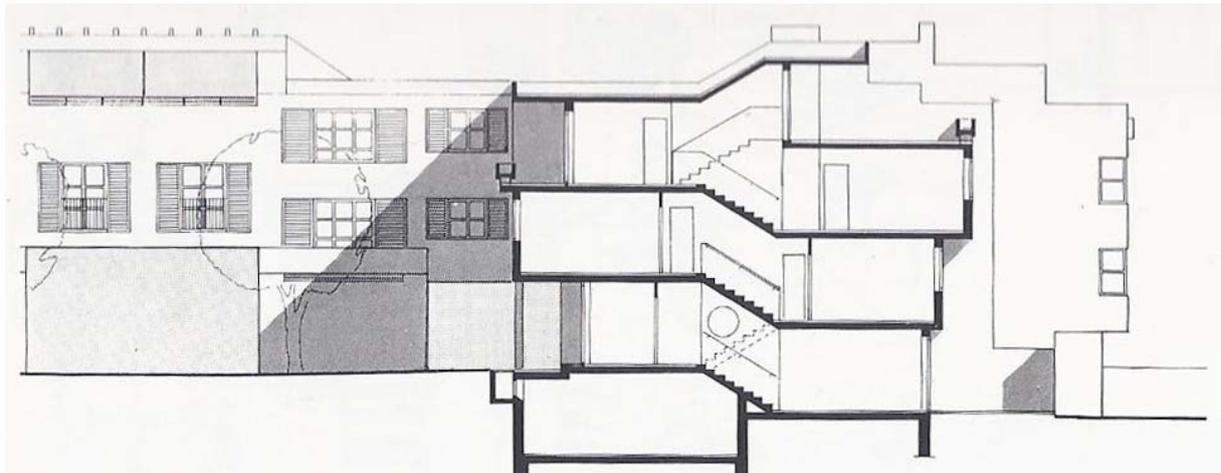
Wohnhausanlage "Gerasdorfer Straße", Schnitt
